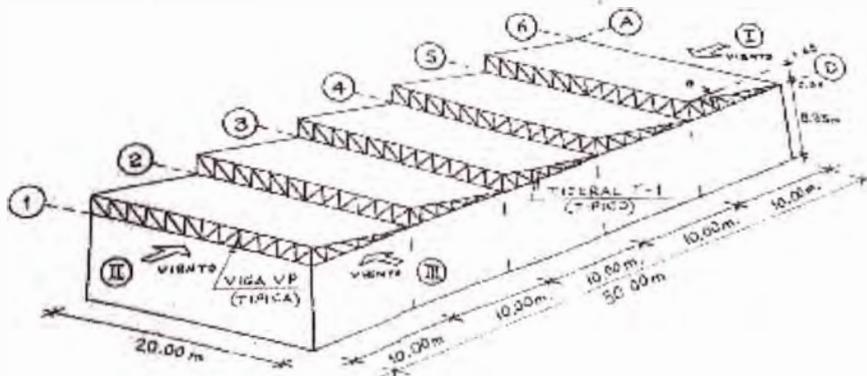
Esquema de Techo plano tipo diente de sierra.
